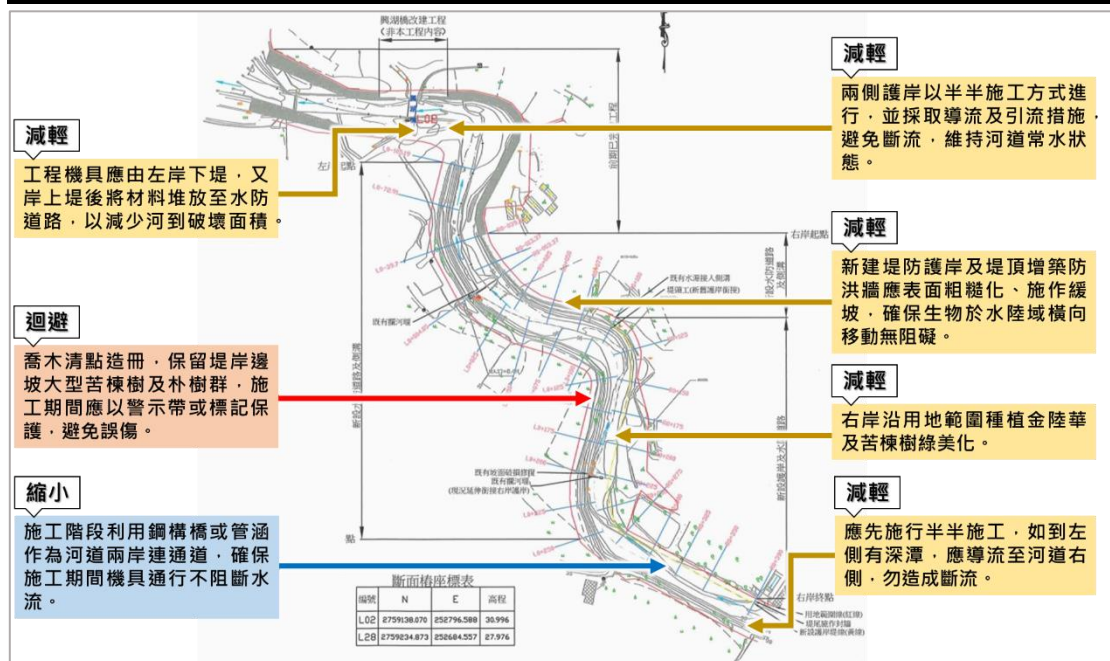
六股溪排水福龍段改善工程(二)施工階段生態友善措施平面圖
